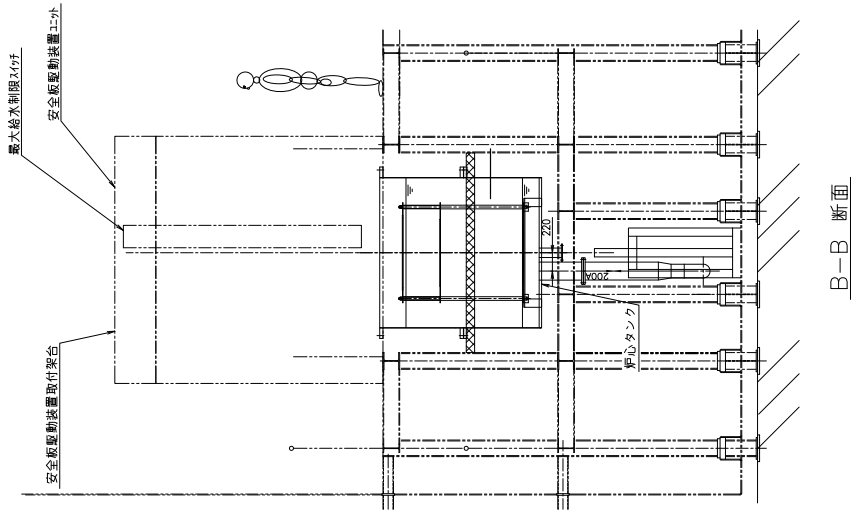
(2) 配管配置図 (炉室 (S) 断面)
